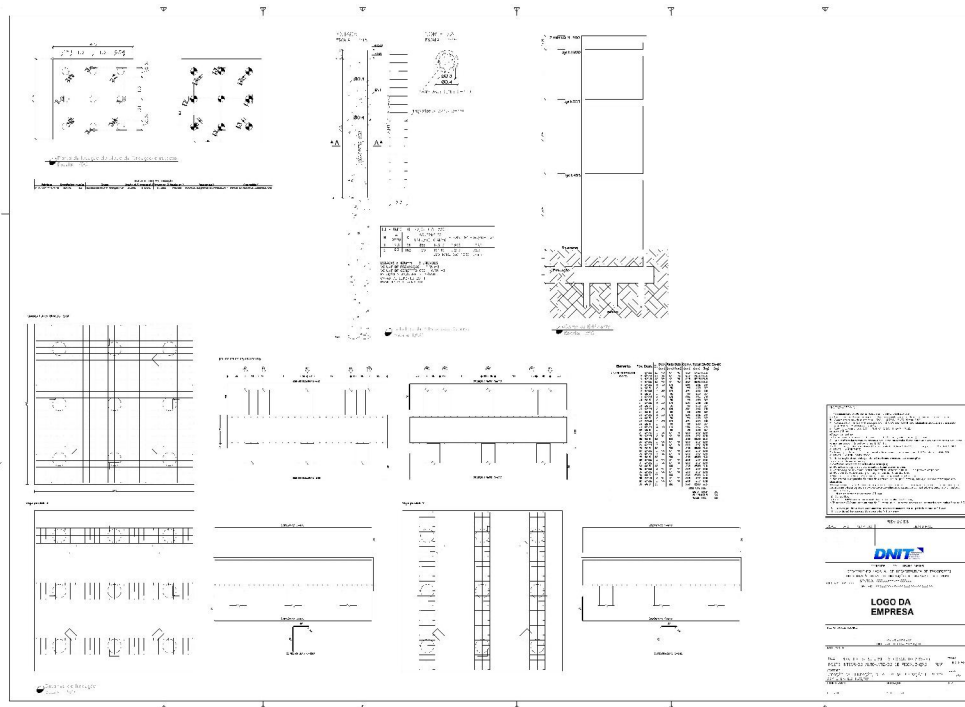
Locação da fundação, detalhes da fundação e estaca / corte da edificação.
